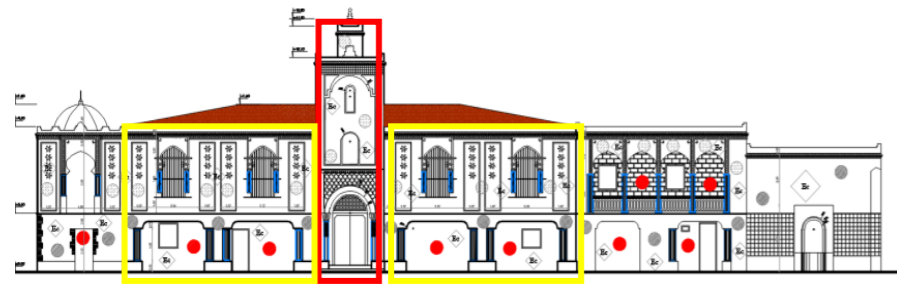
Façade ouest. Source: BET Handassa wa Bina.
